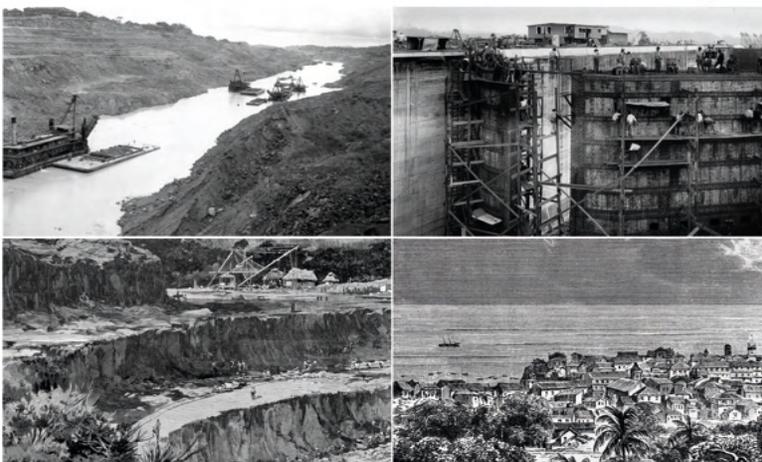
Dragas trabalhando na construção do Canal do Panamá; homens na construção de uma das eclusas do canal; escavações na tentativa francesa de construção do canal; vista da Cidade do Panamá em 1878.
